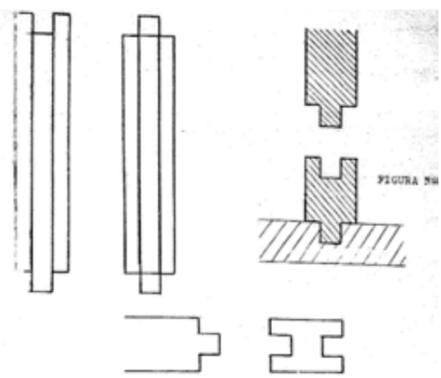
Columnas y módulos de hormigón prefabricados (Patentscope, 1981).
